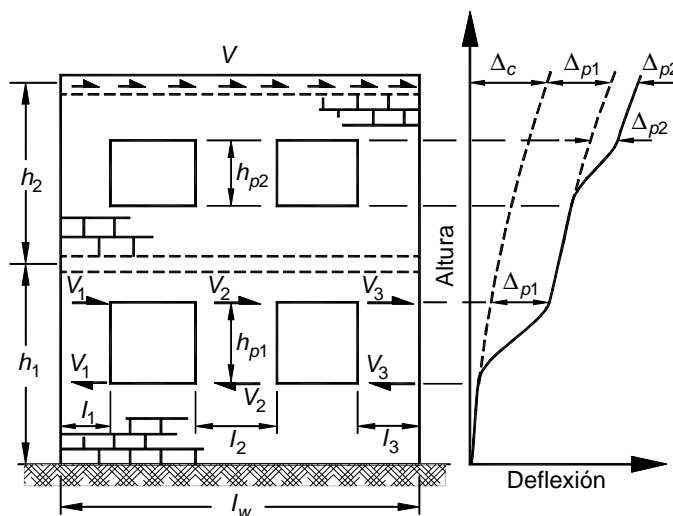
Deformaciones debidas a fuerzas laterales en una estructura de mampostería con aberturas (Paulay y Priestley, 1992)
